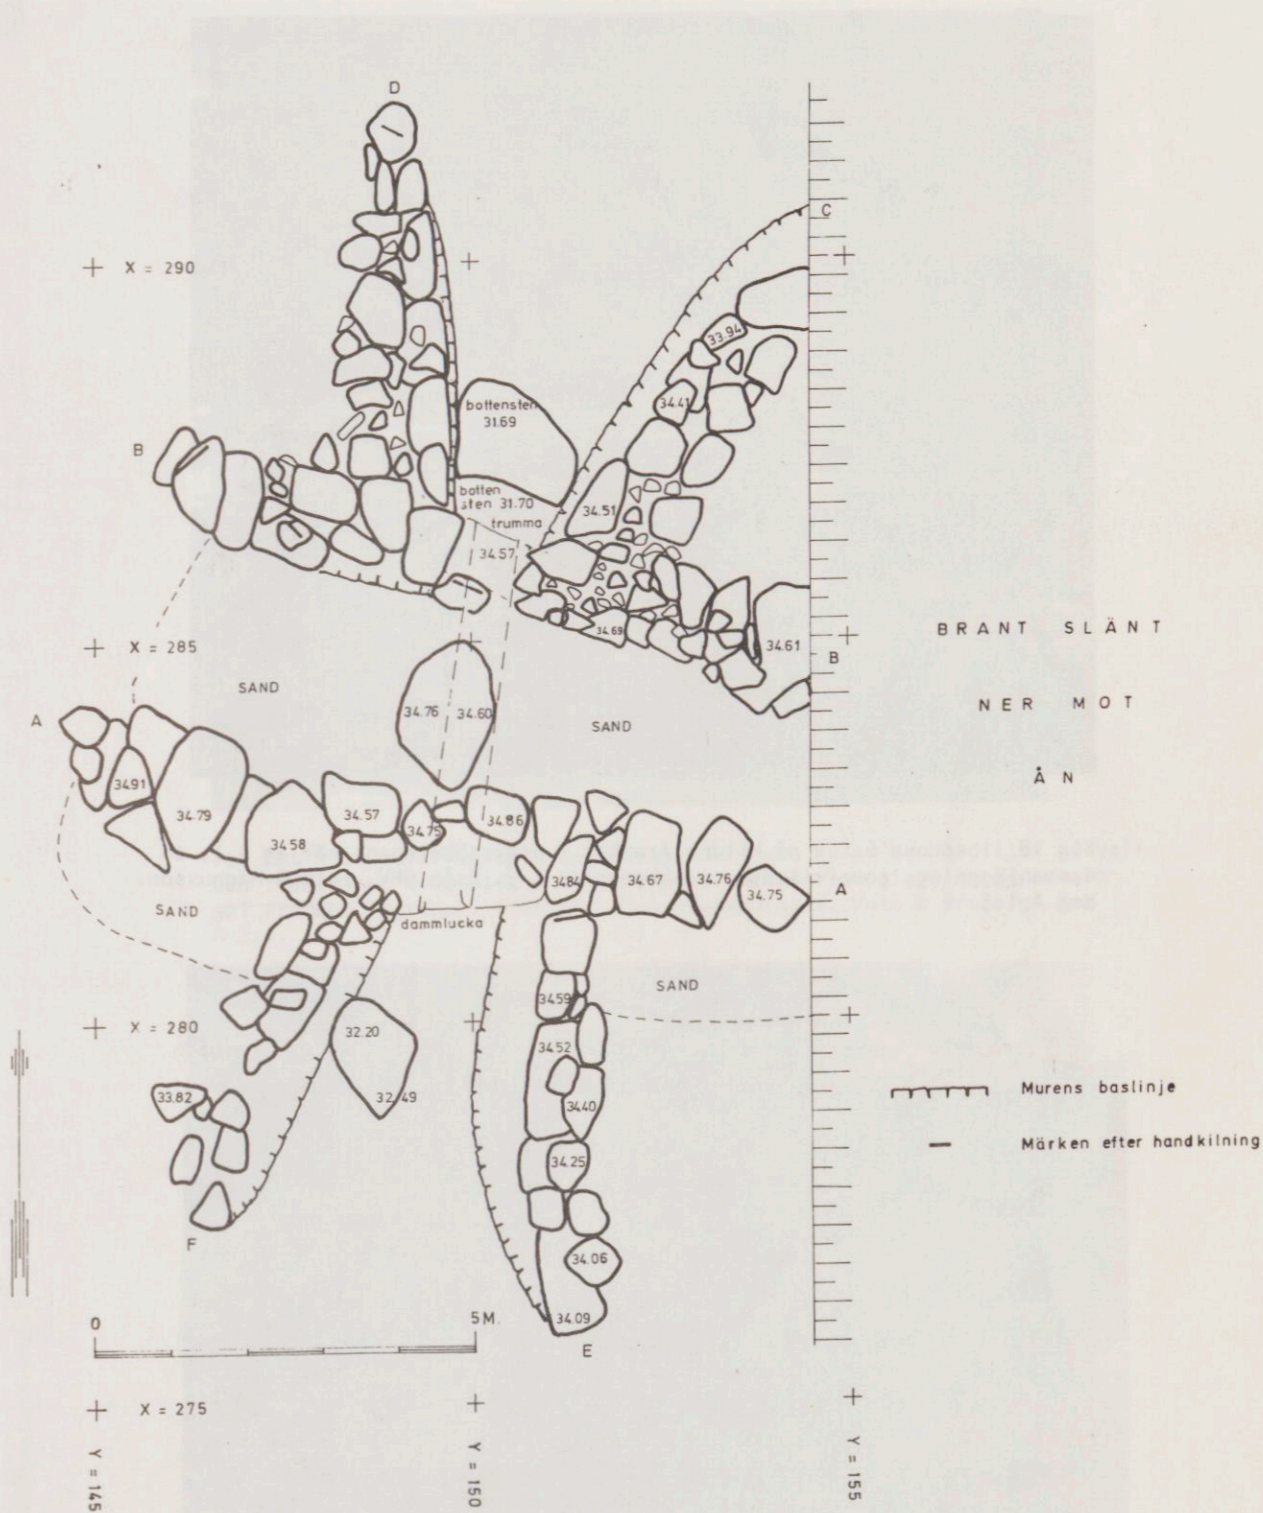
Plan över A 1, damkonstruktion. Skala 1:100.
